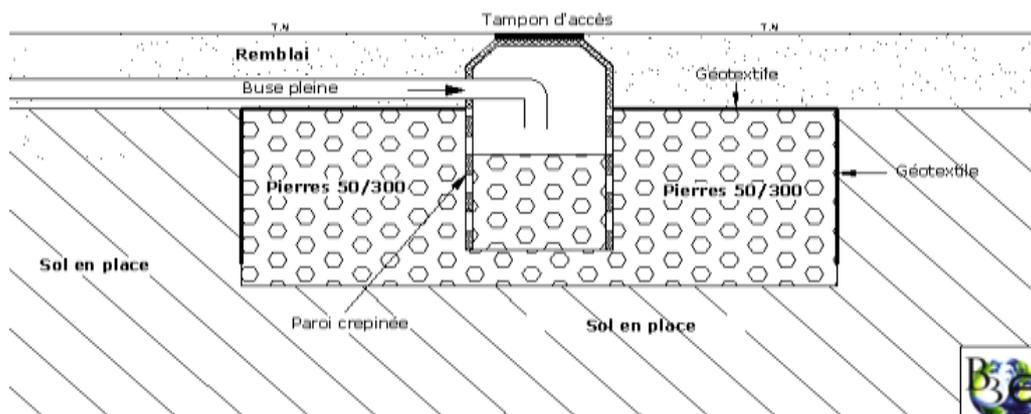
Coupe schématique d'un puits d'infiltration (source : B3E)
